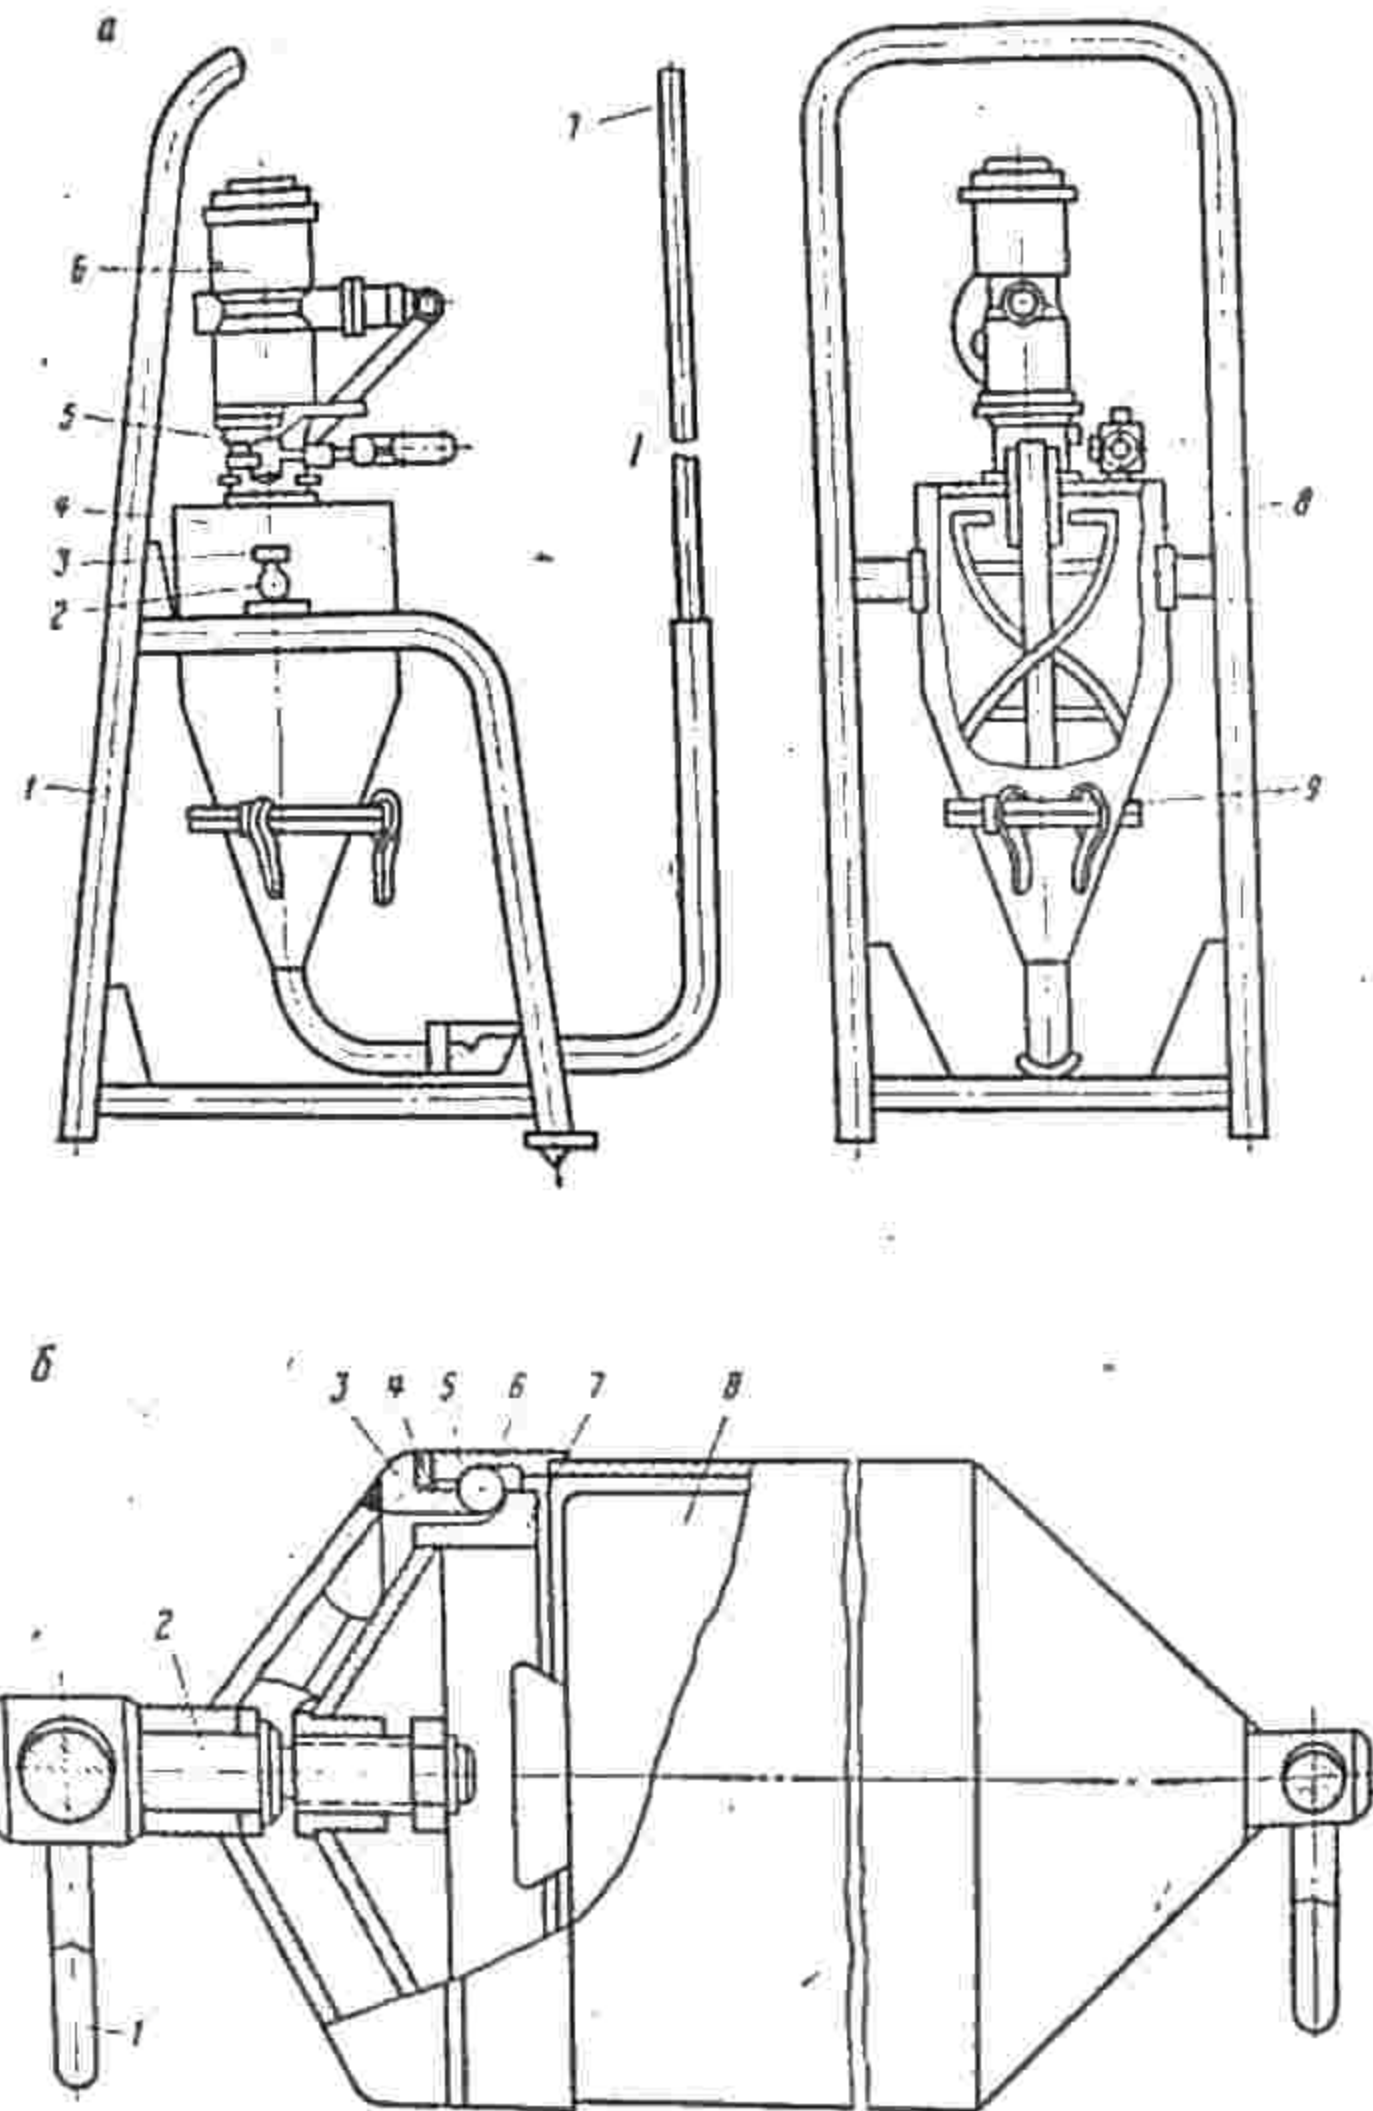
Комплекс оборудования для возведения железобетонной аккерной крепи ПН-1
